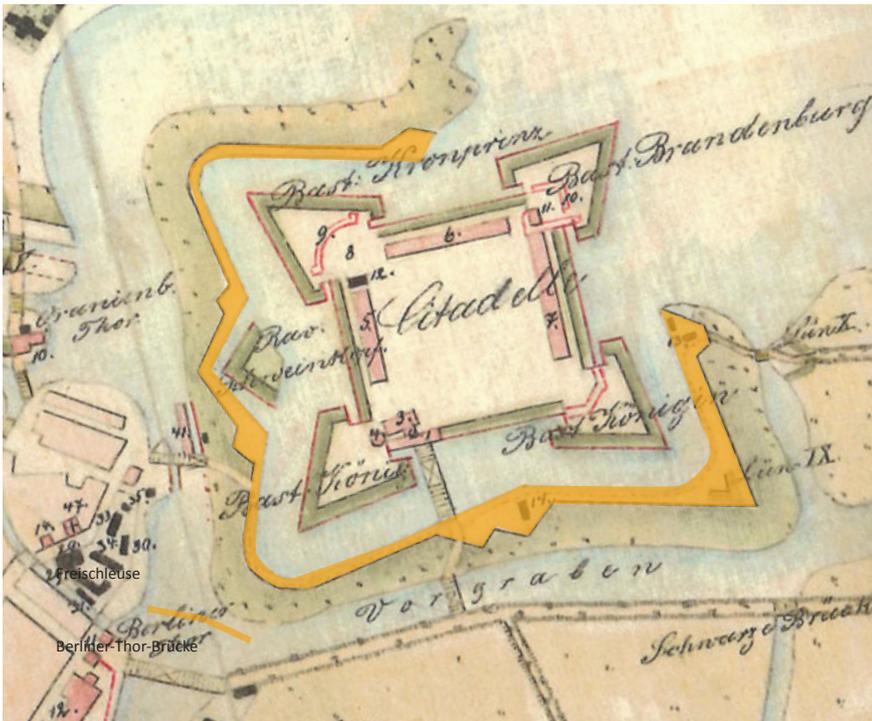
1855 - Grundriss der Festung Spandau (Archiv des Stadtgeschichtlichen Museums Spandau)
